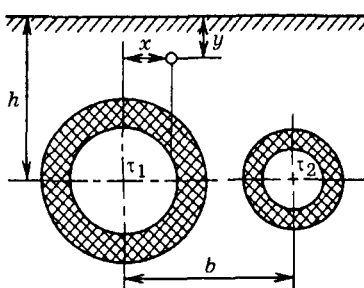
Схема двухтрубного бесканального теплопровода
